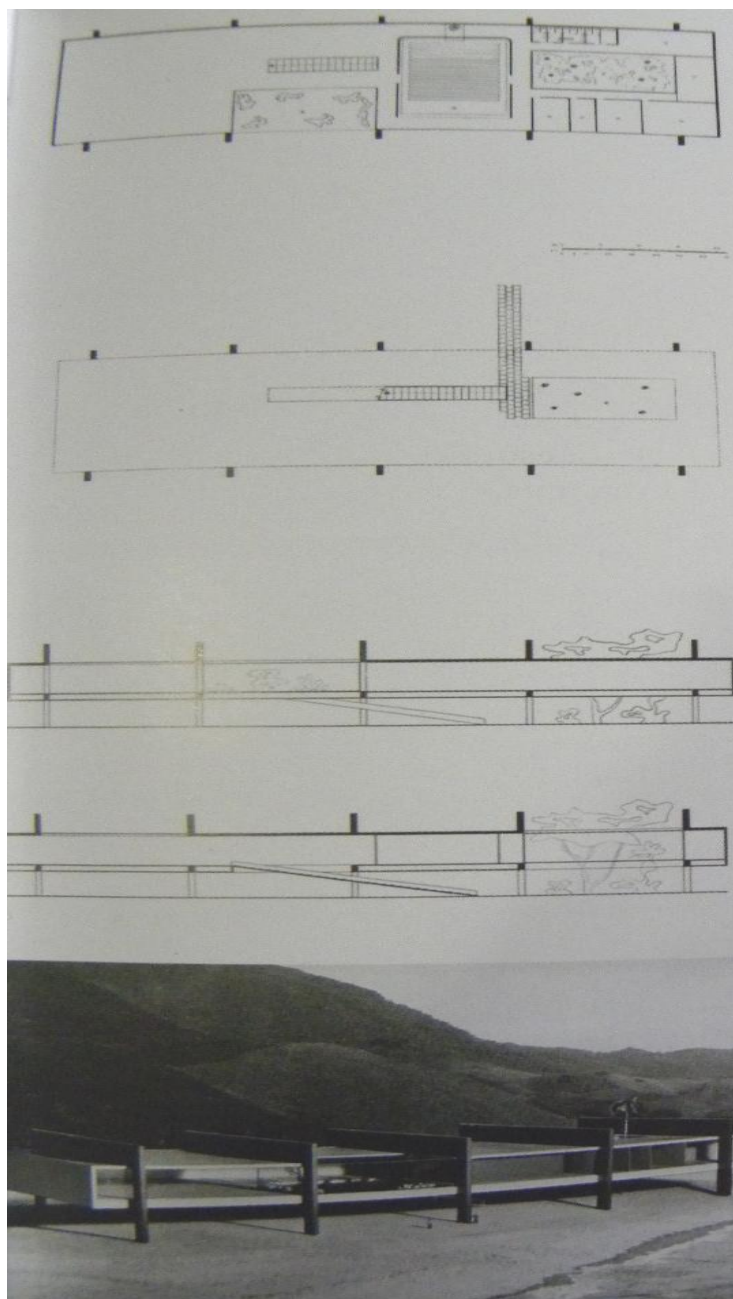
De cima para baixo temos a planta do pavimento superior do Museu de São Vicente; planta do nível da praia; cortes; fachada para o oceano em fotomontagem com maquete.
